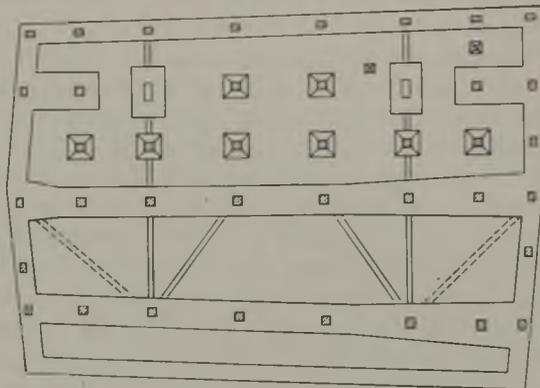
Grundriß des Geschäftshauses Sinn in Essen.
